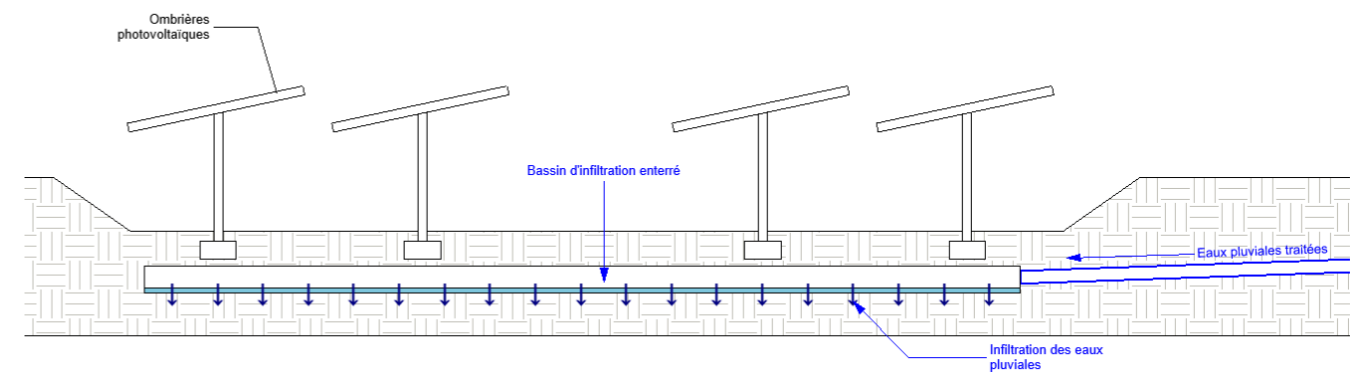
Coupe au droit du parking VL et implantation du bassin d'infiltration enterré
